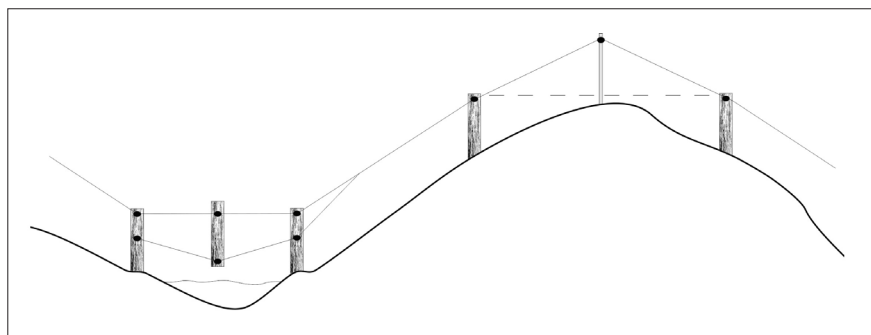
Esquema para construção de cercas em terrenos irregulares
